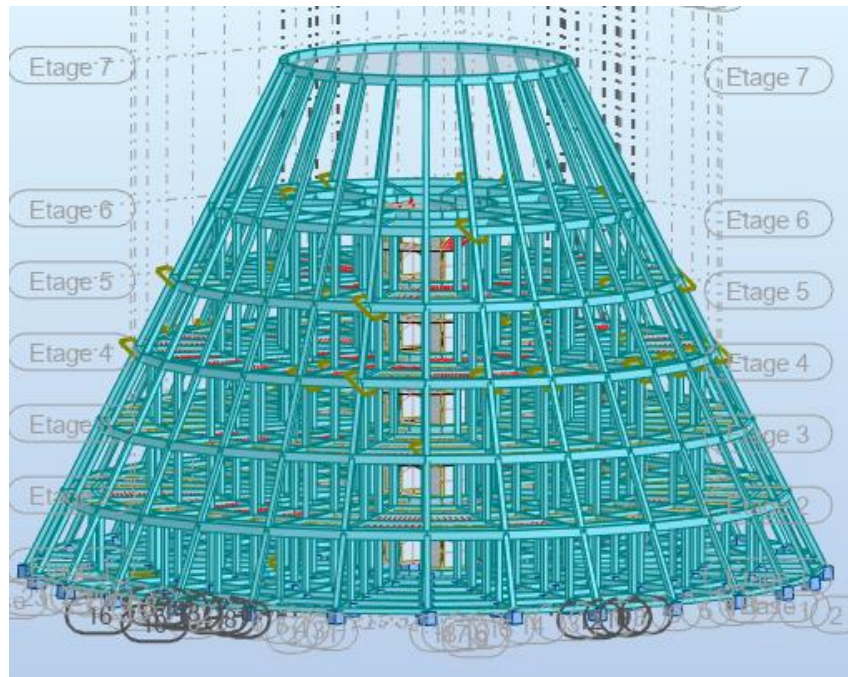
Vue en élévation du schéma structural de l'ouvrage [RSAP]
